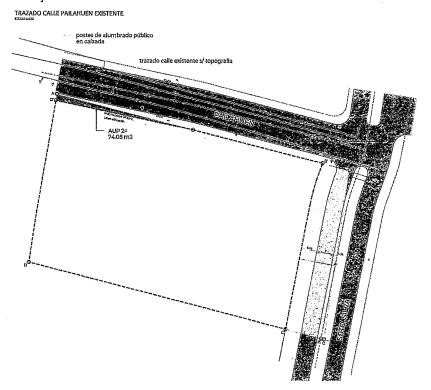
Situación existente de descalce entre trazado de calle existen el PRC Puerto Montt y el proyecto presentado.
